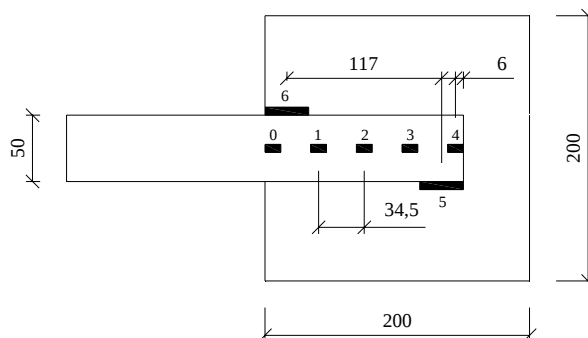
Posicionamento dos extensômetros elétricos no tecido e no concreto nos corpos-de-prova do grupo A exceto o L50-R25-1/piloto (medidas em mm).
